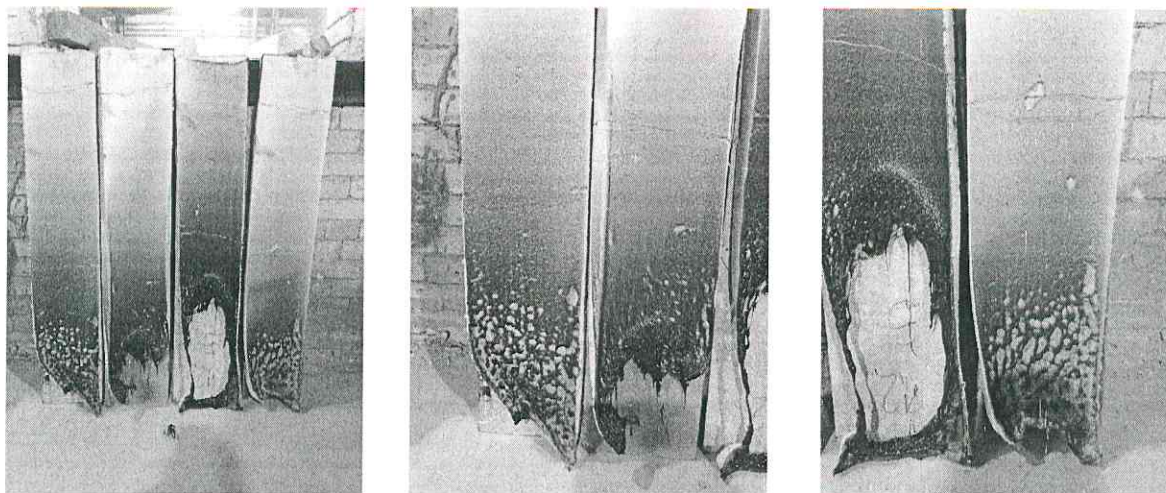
Фото образца № 10-07-2023-001 после испытаний
